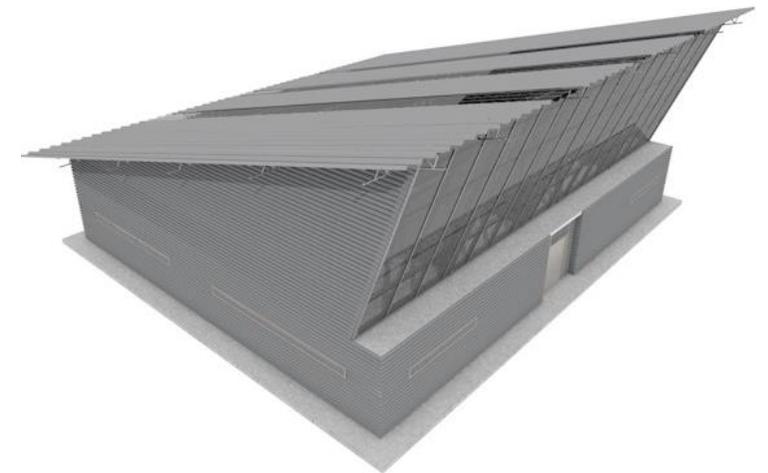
Elevación Oeste de Ingeniería Metalúrgica hangar. Archivo propio. 2017.
